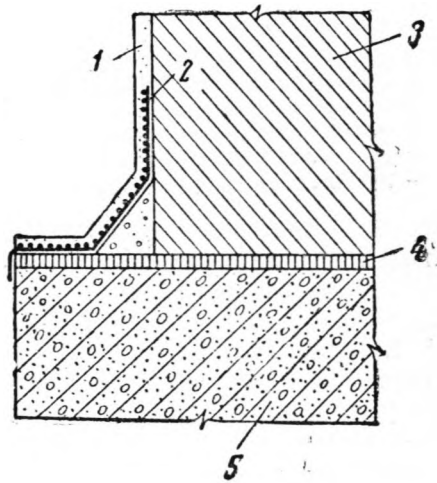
Усиление гидроизоляции при переходе с горизонтальной поверхности на вертикальную
